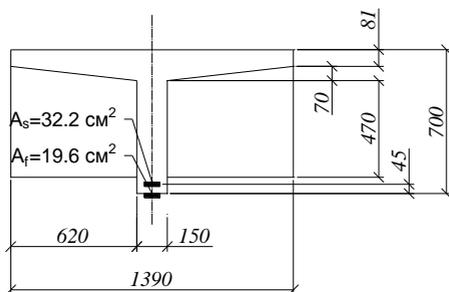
Сечение балки по типовому проекту СДП выпуск 56, усиленной устройством дополнительного внешнего армирования растянутой зоны
